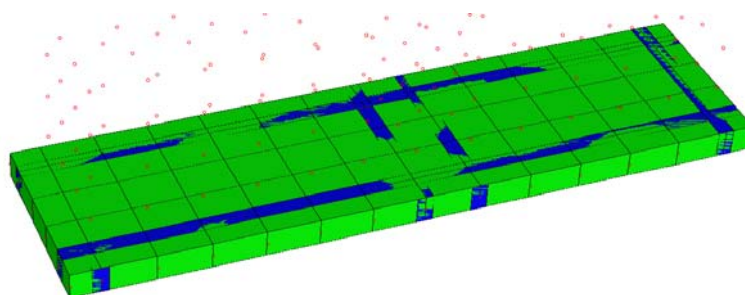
Vista 3D Platea di Fondazione con Travi di Collegamento
